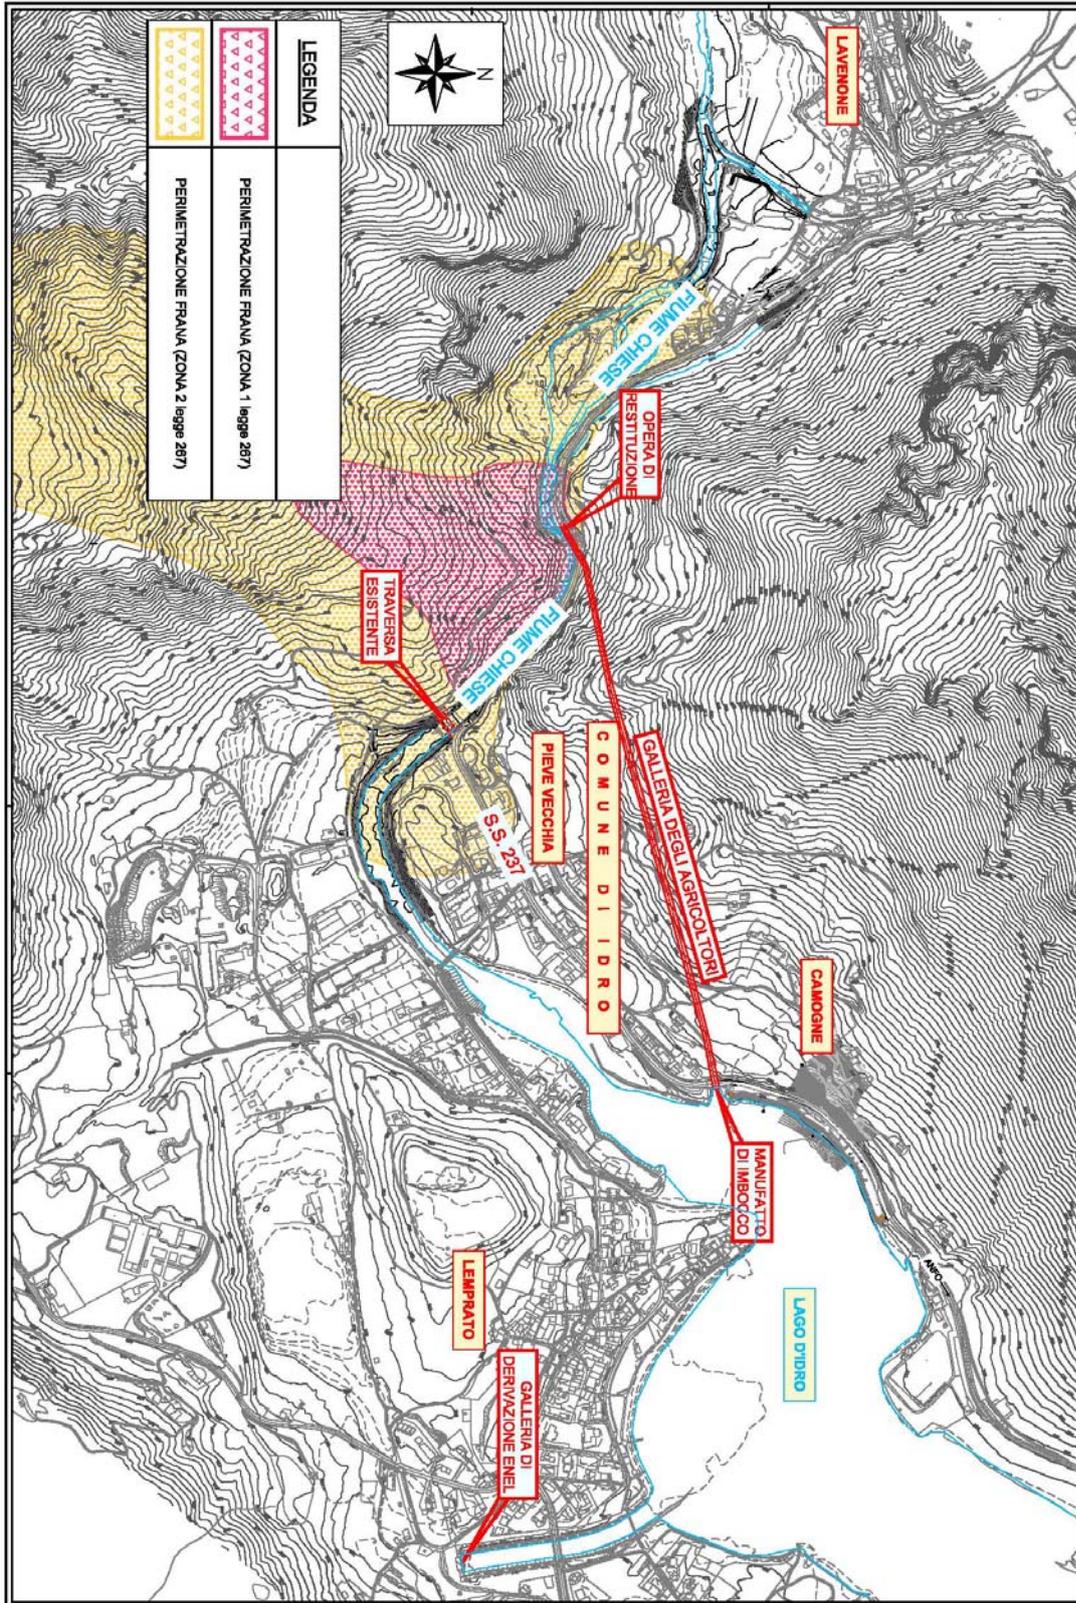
planimetria dello stato di fatto con perimetrazione del pendio in frana (legge 267/98: aree ad elevato rischio idrogeologico)
